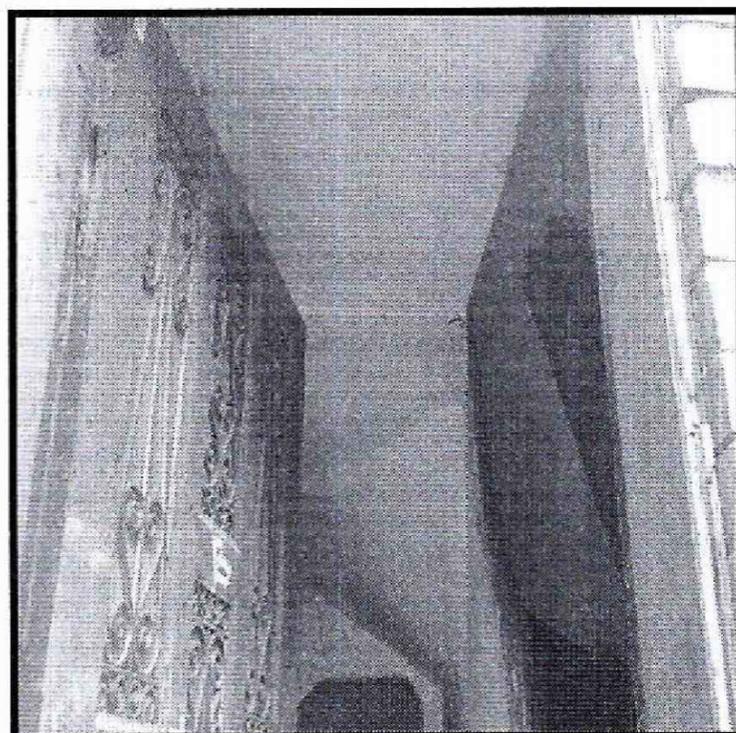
y 4. Desprendimiento del enchape en la fachada principal del segundo nivel del predio ubicado en la Carrera 5B No 27 80 en el Sector Catastral San Diego de la Localidad de Santa Fé.
